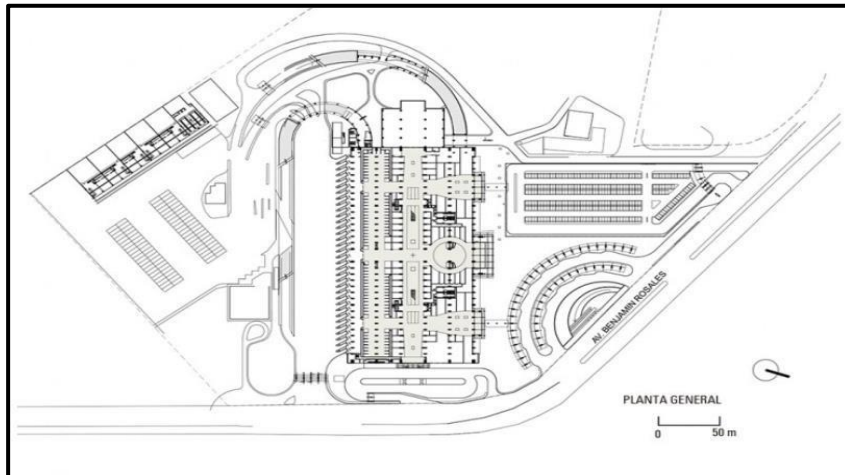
Planta General del Terminal Terrestre de Guayaquil
